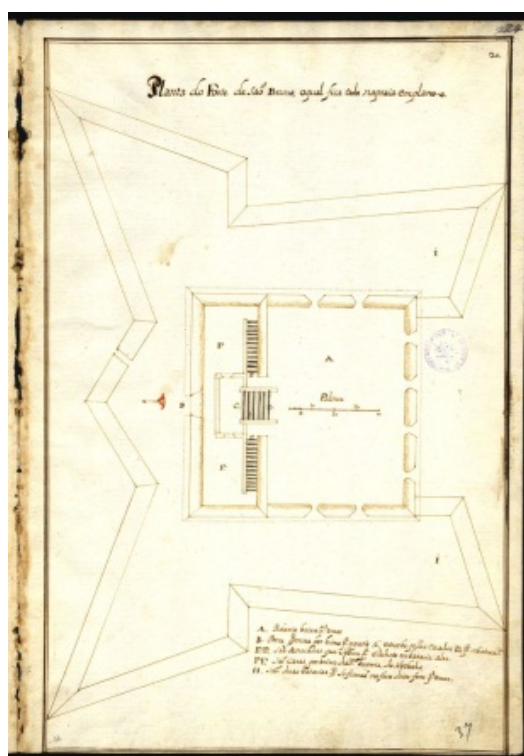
Planta do Forte de São Bruno o qual fica todo na praia em plano (“Plantas deste Reino e Castela” Cota: BNP da-7-a_0074_37_t24-C-R0072, 1699-1743).
